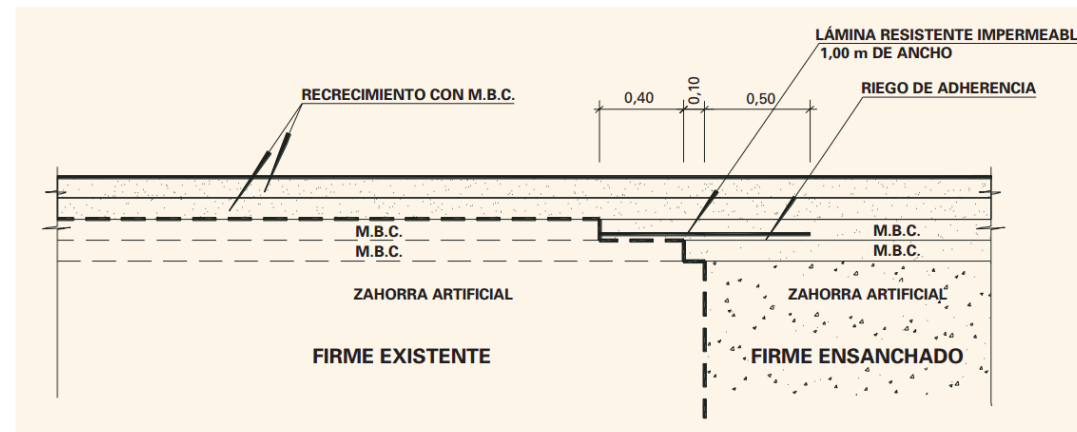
ESQUEMA DE SECCIÓN TIPO DE ENSANCHE DE FIRME
